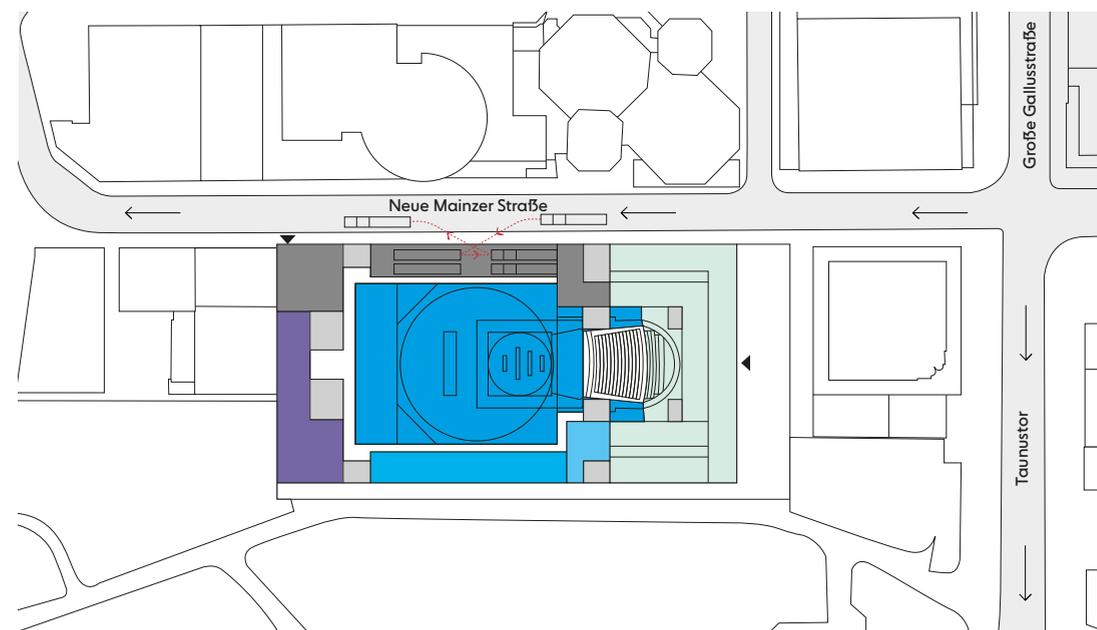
2d Neue Mainzer Straße, Oper mit Probebühnen; Grundriss Erdgeschoss, Schnitt
